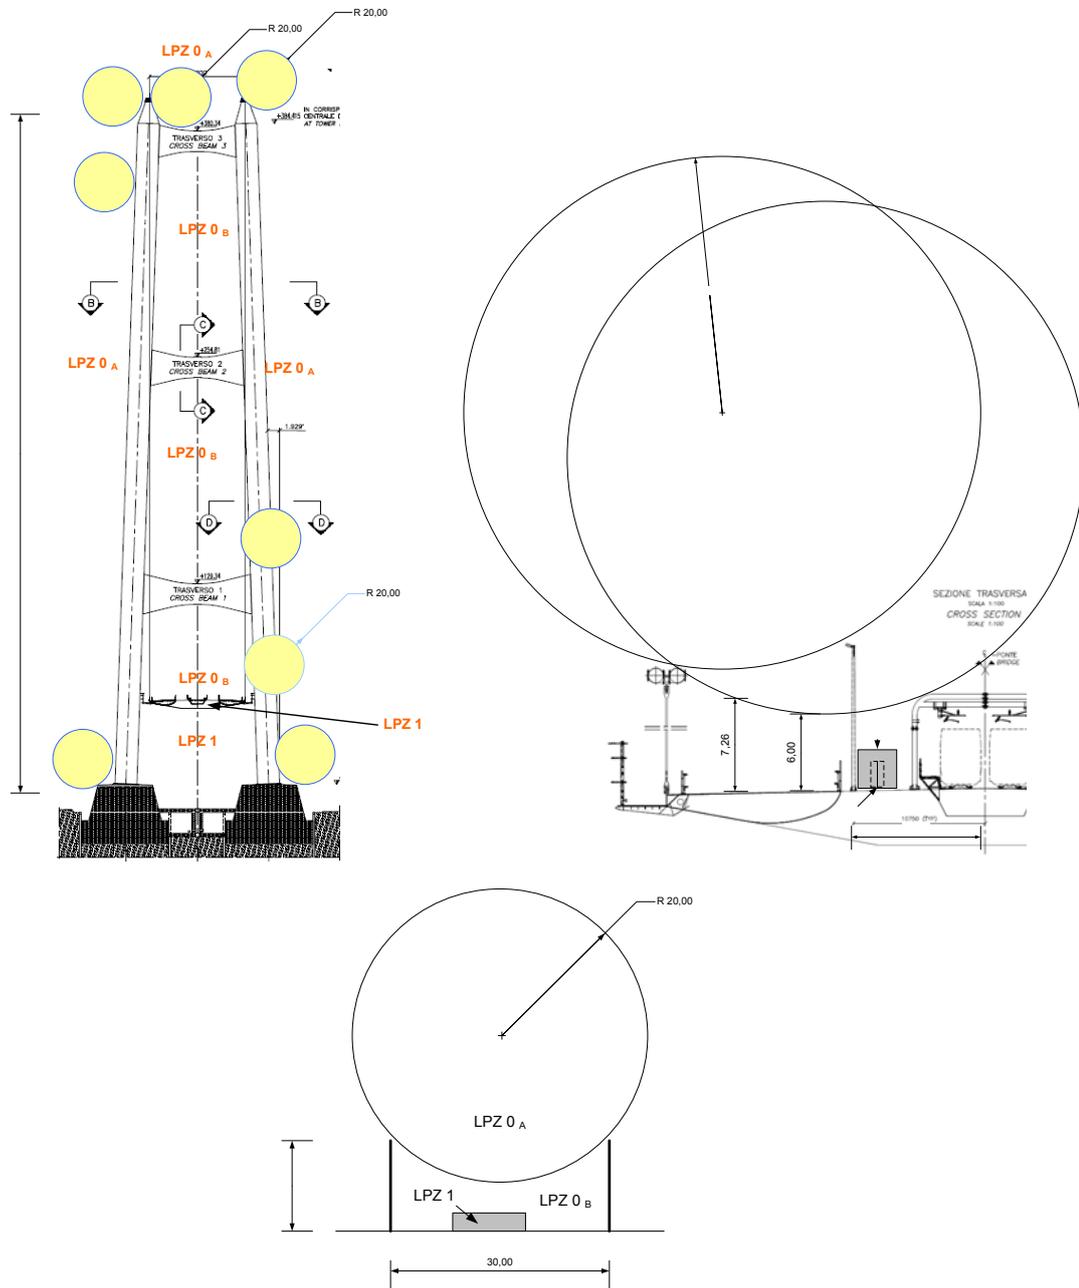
Definizione delle zone di protezione da fulminazione (LPZ)
